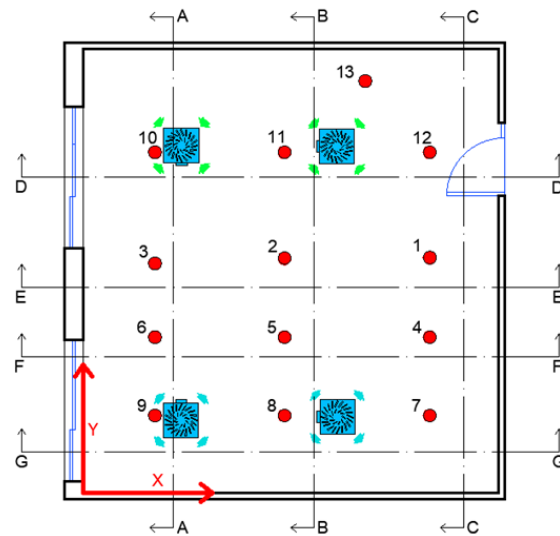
Planimetria con individuazione delle sezioni di riferimento: E-E; F-F
